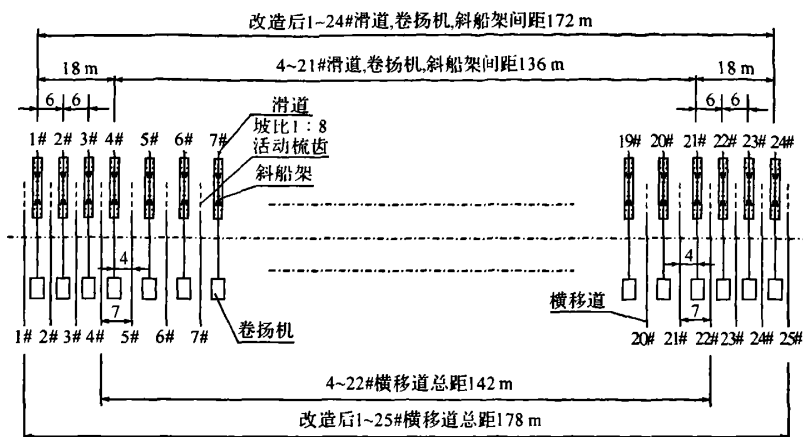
梳式滑道系统改造平面布置示意图(尺寸单位:m)
